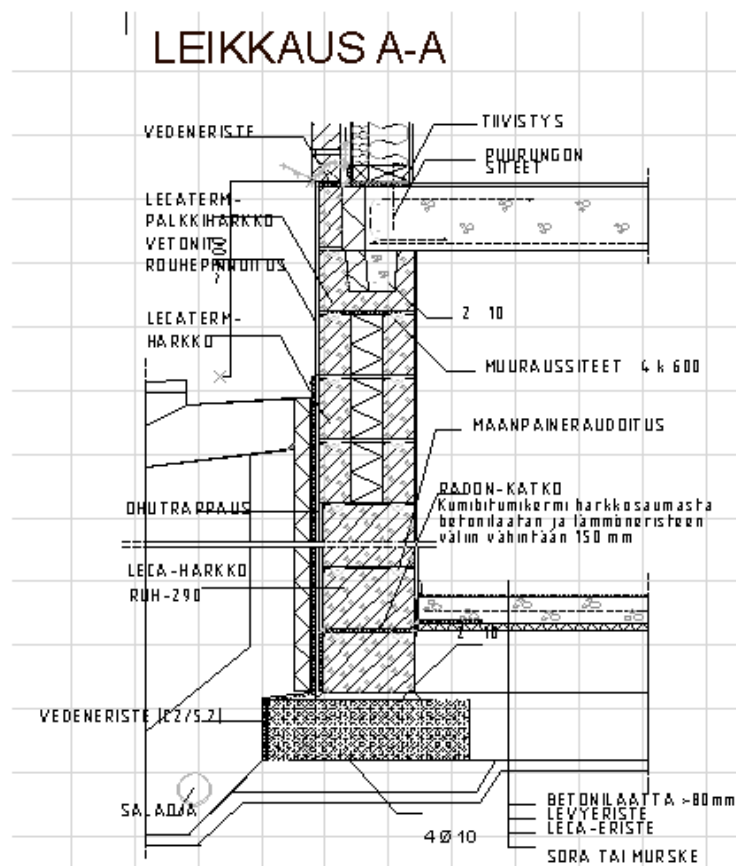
Pientalon kellarin runko: paikallavalettu teräsbetonilaatta /1/
